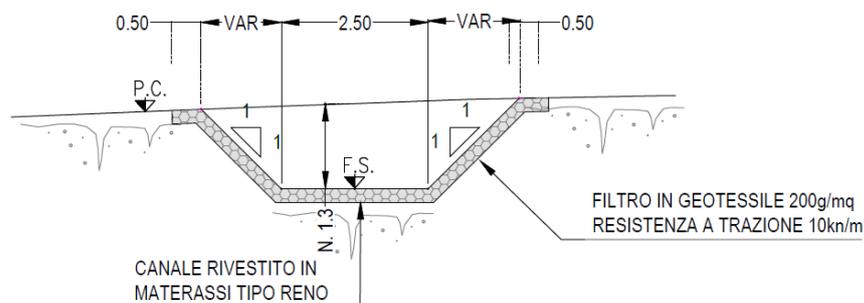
Sezione tipo del canale rivestito in materassi tipo reno.
